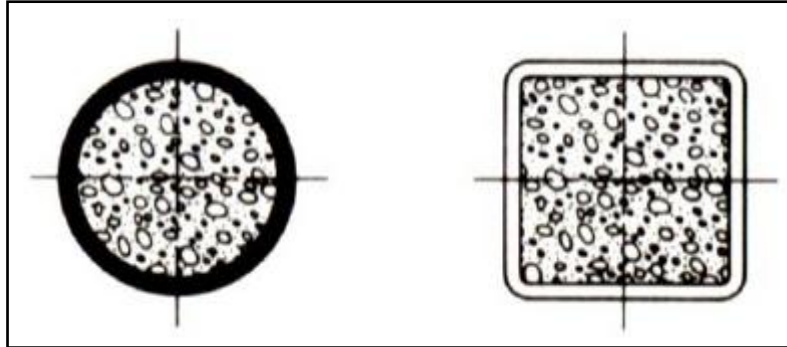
[Columna de tipo mixta (acero estructural – hormigón)]
